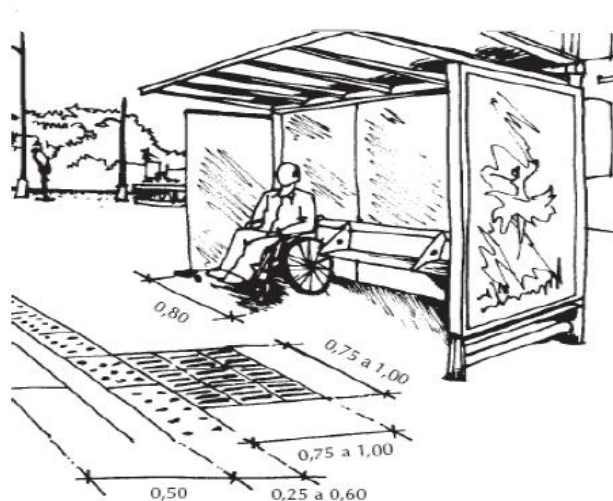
Sinalização do abrigo com pavimento tátil
